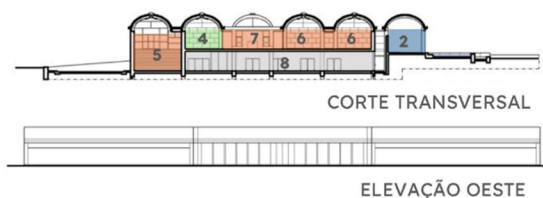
Corte e fachada | Fonte: Archweb adaptado pela autora.
